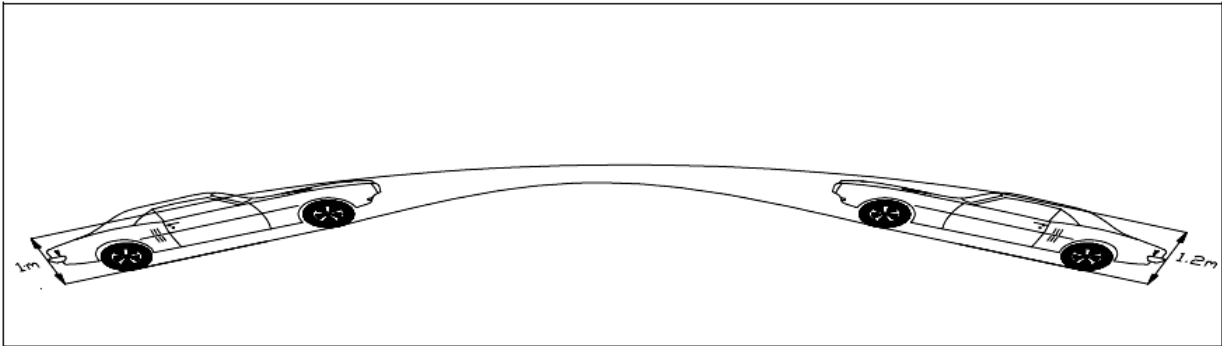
Visibilité sur chaussée bidirectionnelle. [Y. MADOURI ; A. ZAROUALI.2012]
